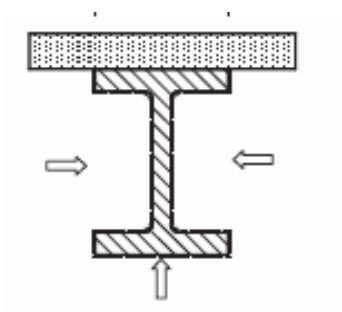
Proteção da Viga do Piso - Argamassa Projetada Blaze Shield II.
